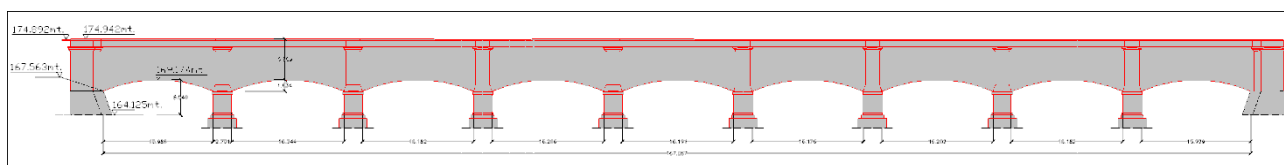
Prospetto di rilievo del ponte canale Cavour.
